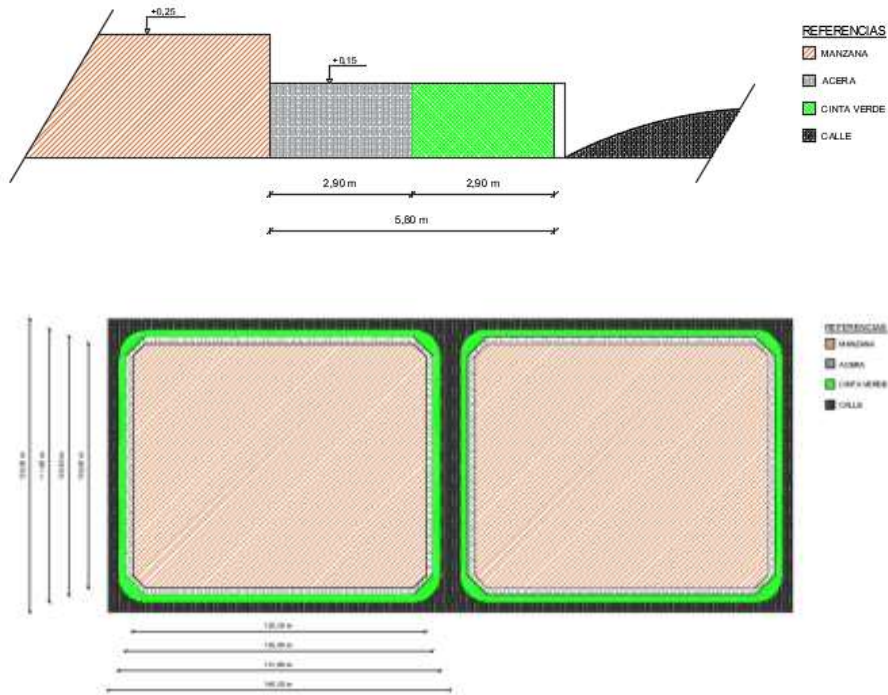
Distribución de superficies en lote, manzana, vereda y calle.
